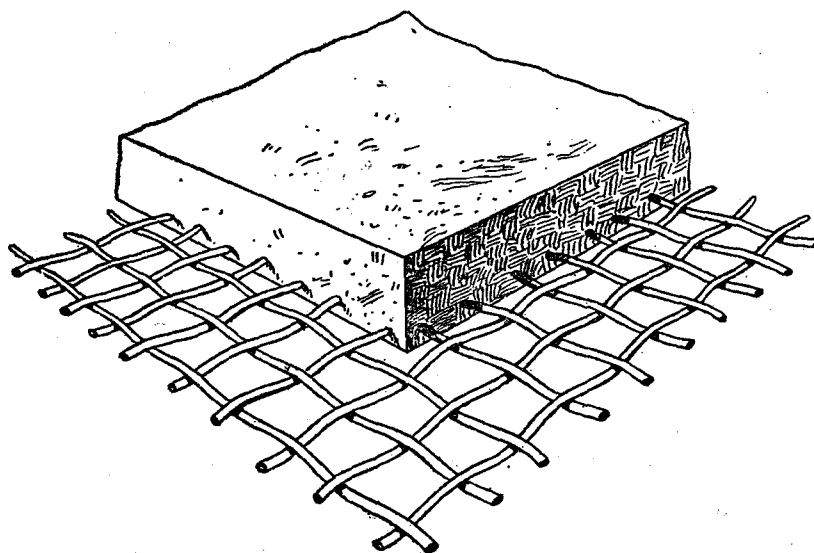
Losa de hormigón armado, sistema *Cottancin*.
